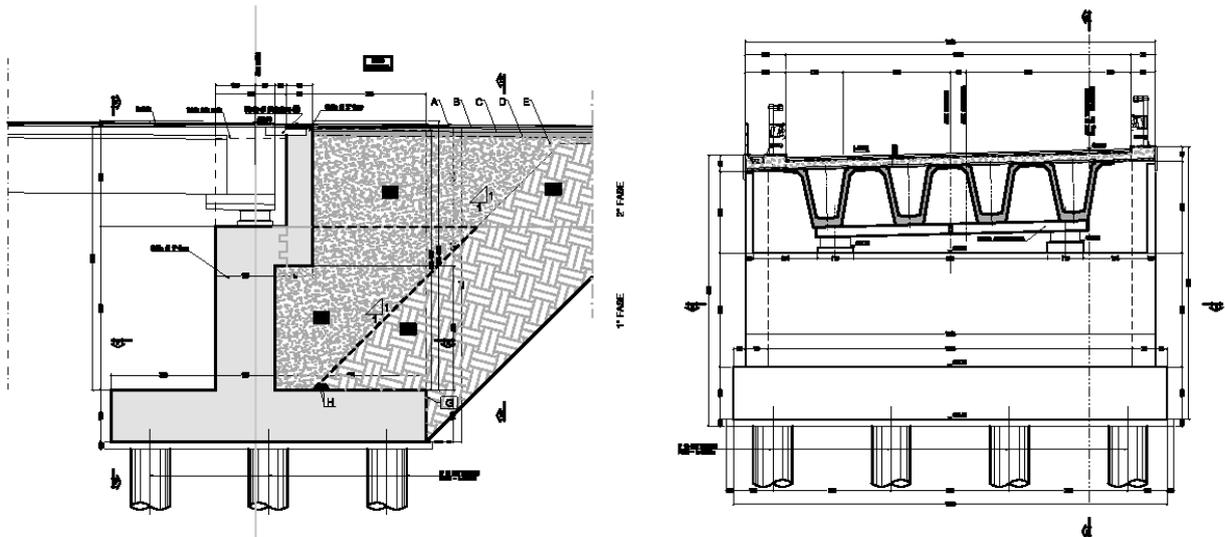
Sezione longitudinale SpB_SX e Vista frontale SpB_SX
